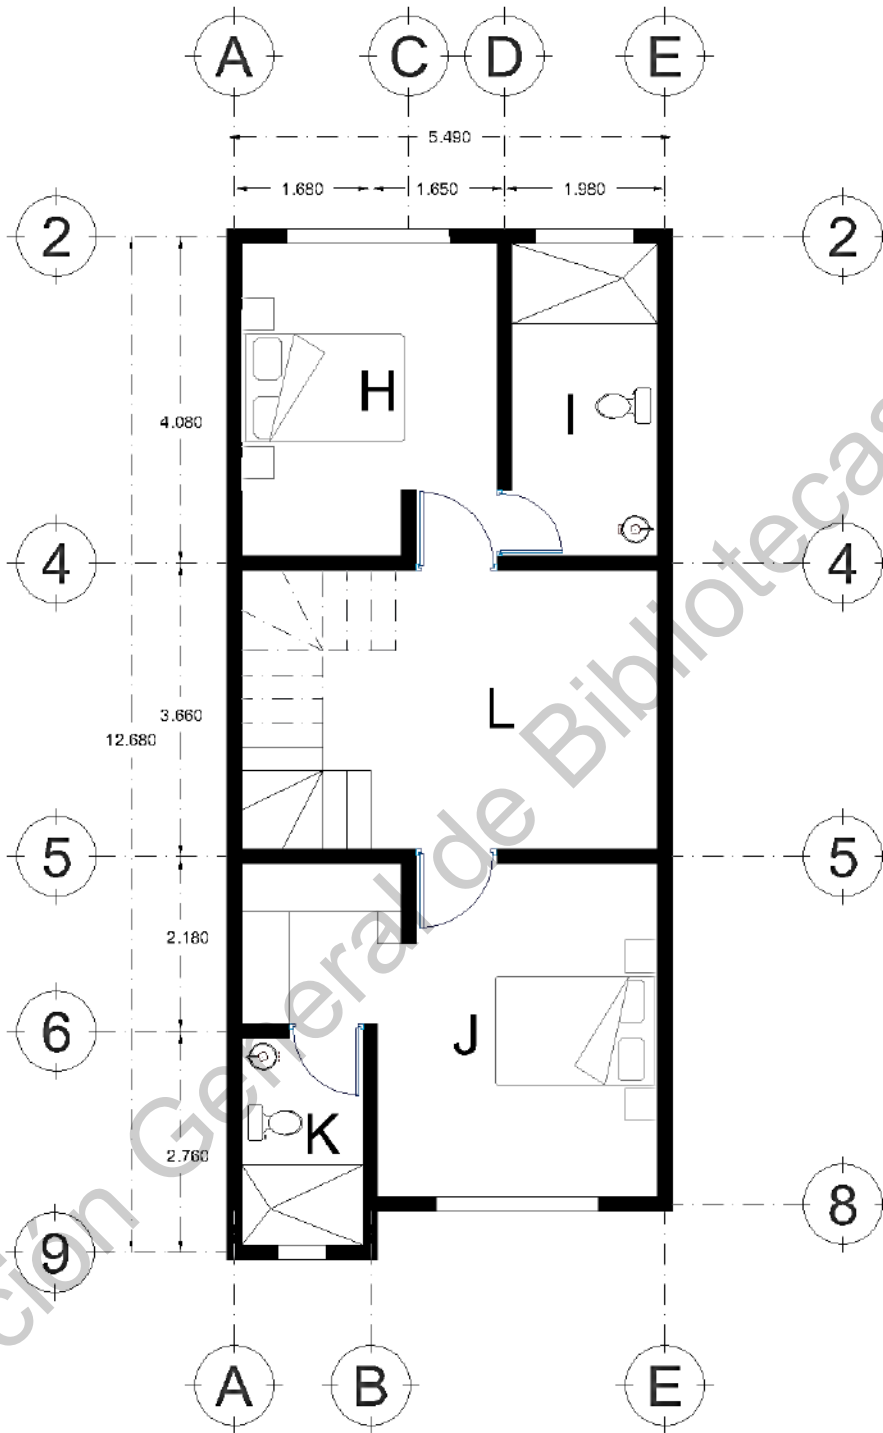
Planta Arquitectónica Alta. Casa Viñedos.
